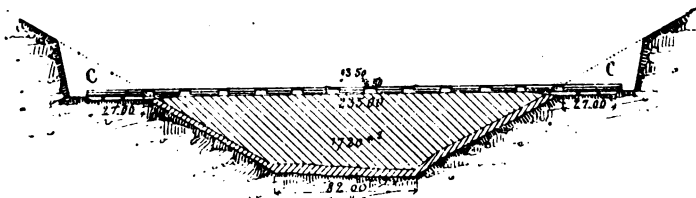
Coupe longitudinale du barrage de la Gileppe.
